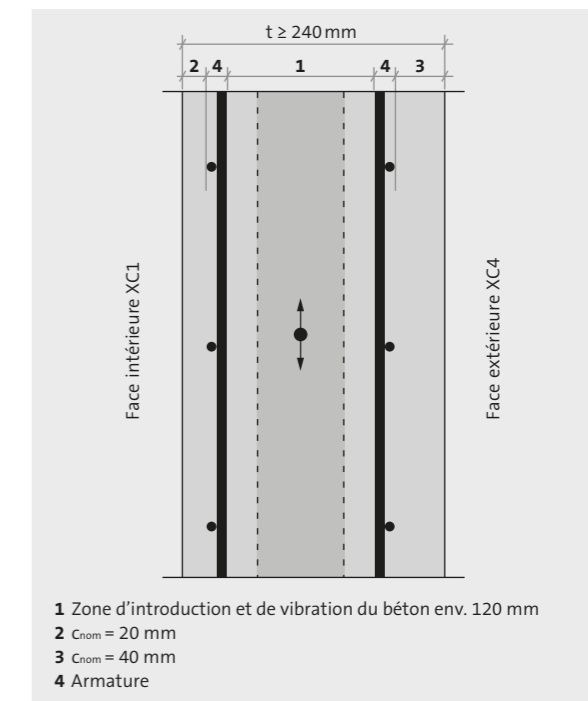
Détermination de l'épaisseur minimale d'un mur en fonction de l'enrobage, du ferrailage, et du mode de mise en place du béton.
